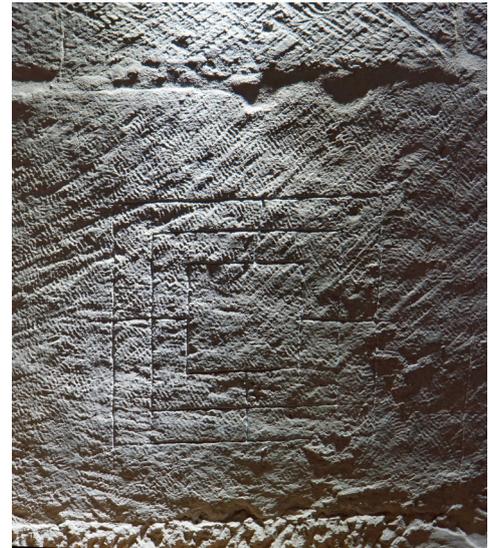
Beobachtungen an Bauteilen erschliessen oft herstellungs- und baugeschichtliche Details, Spuren der Steinbearbeitung; Stiftskirche Saint-Ursanne, JU (S. Holzer)
